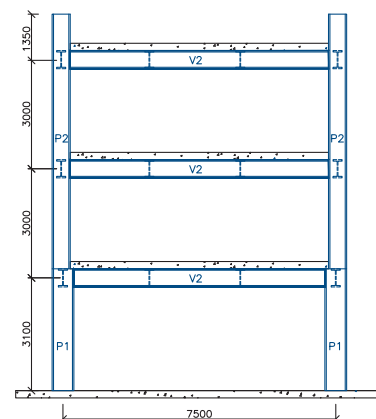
Vista frontal do módulo tipo 1 – corte
